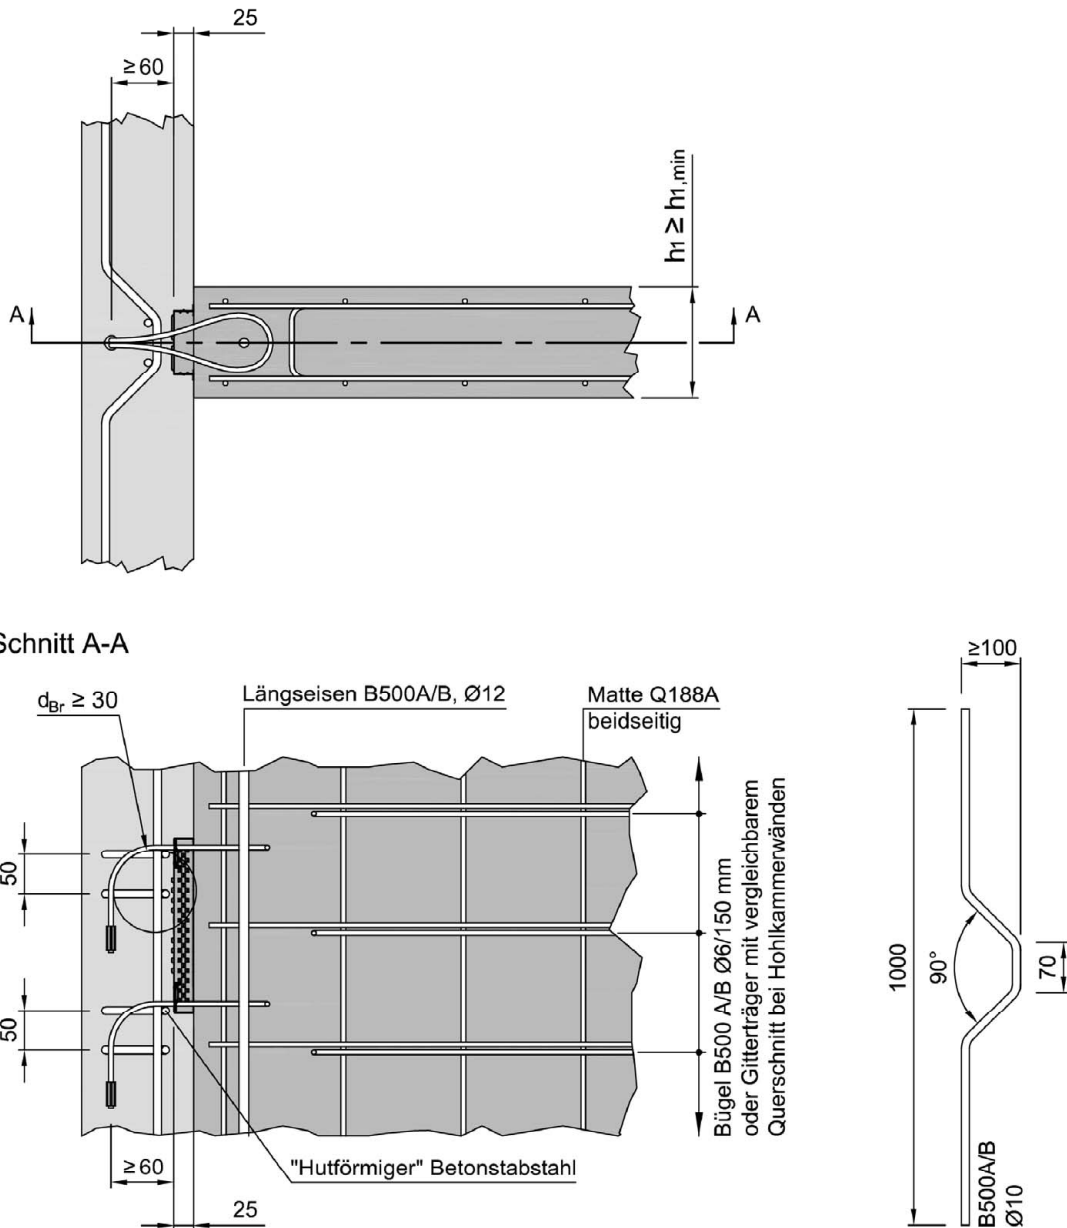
T-Verbindung mit abgewinkelten Seilschlaufen, Abmessungen, Bewehrung
